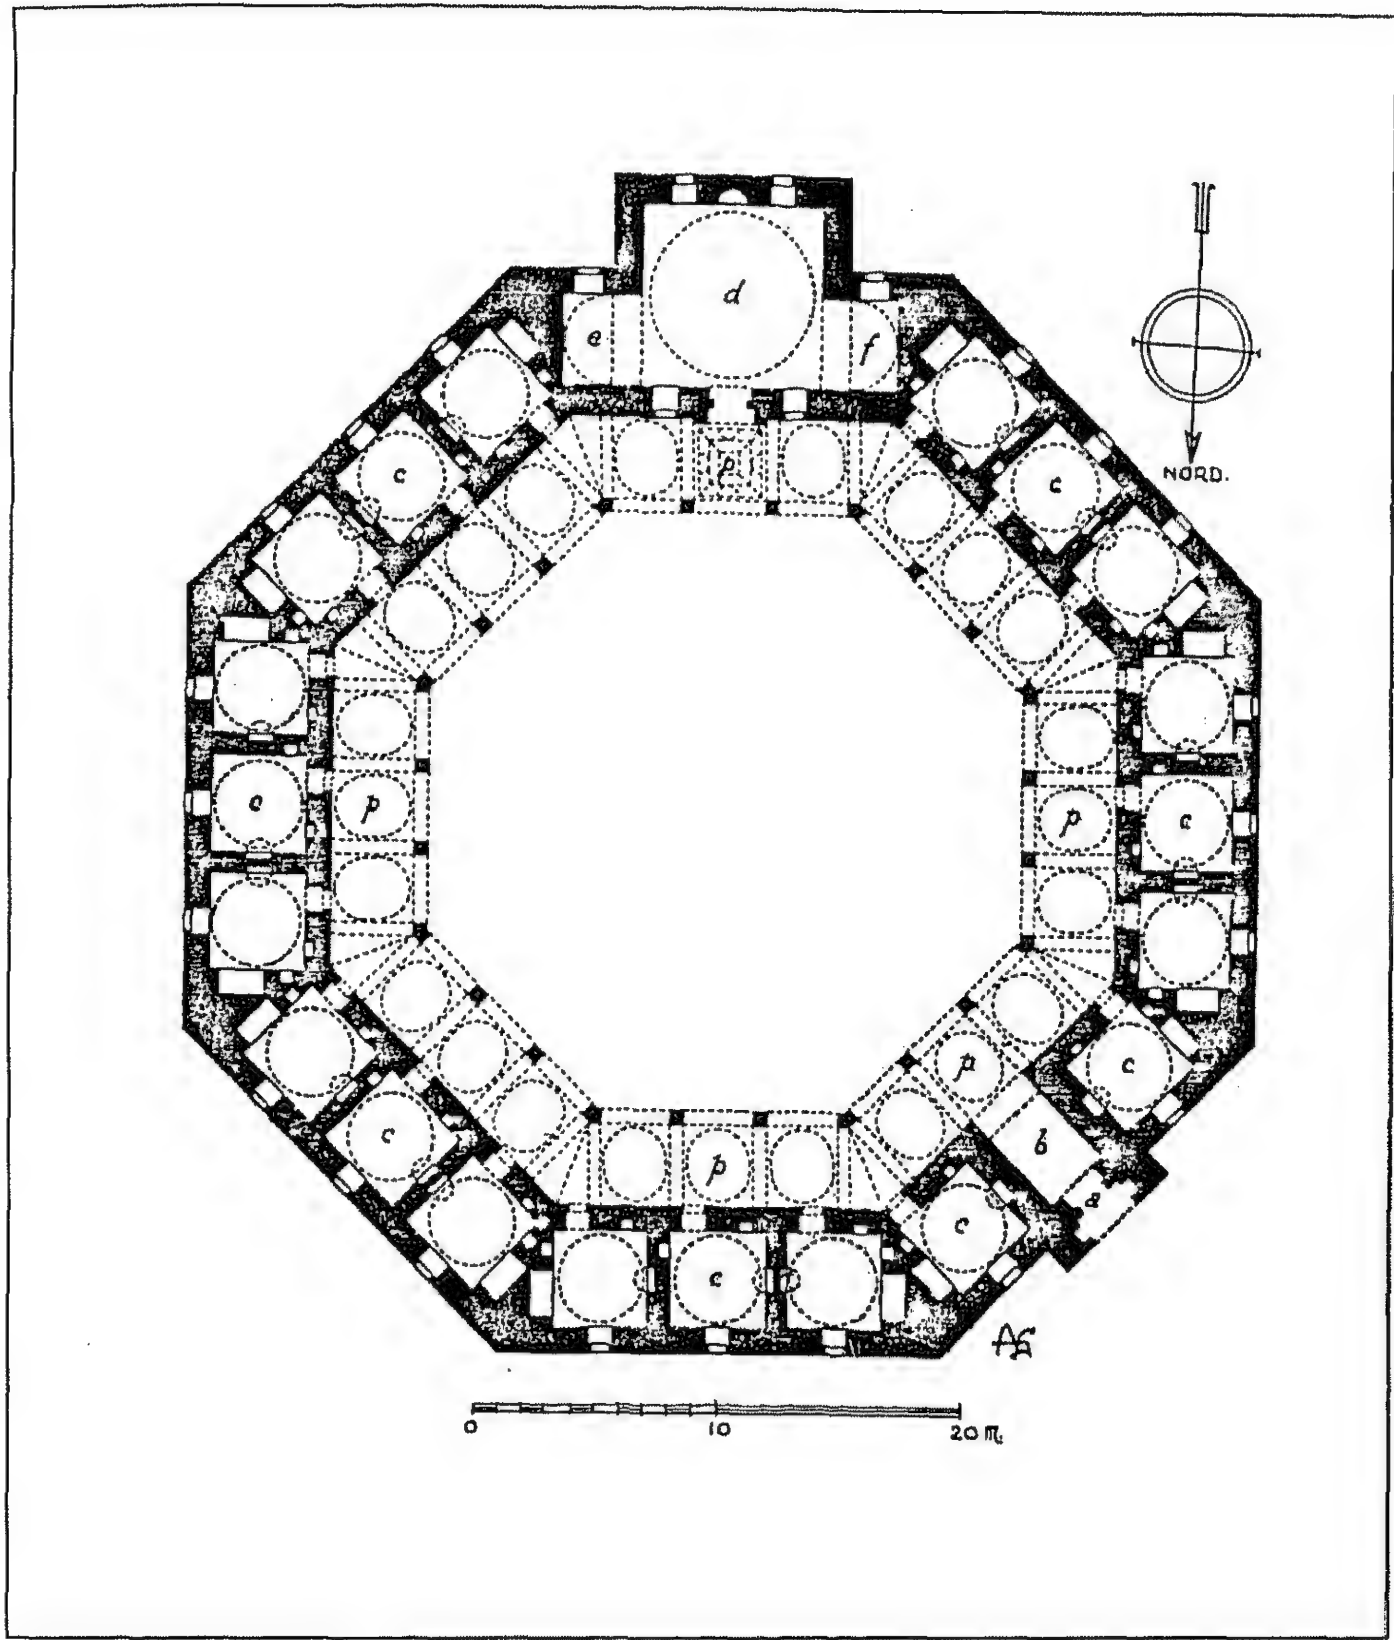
مسقط أفقي لمدرسة الصدر الأعظم قوچه سنان باشا في استانبول
